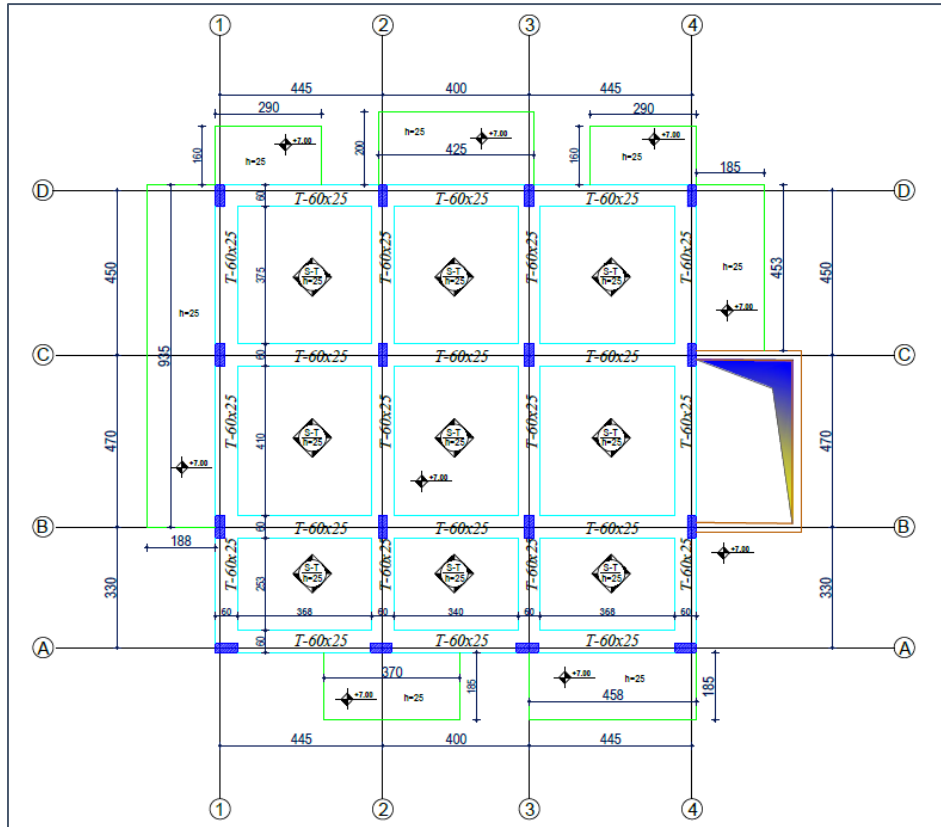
Plani i strukturave kuota +7.00 m dhe +10.15 m (projekti i zbatimit)
